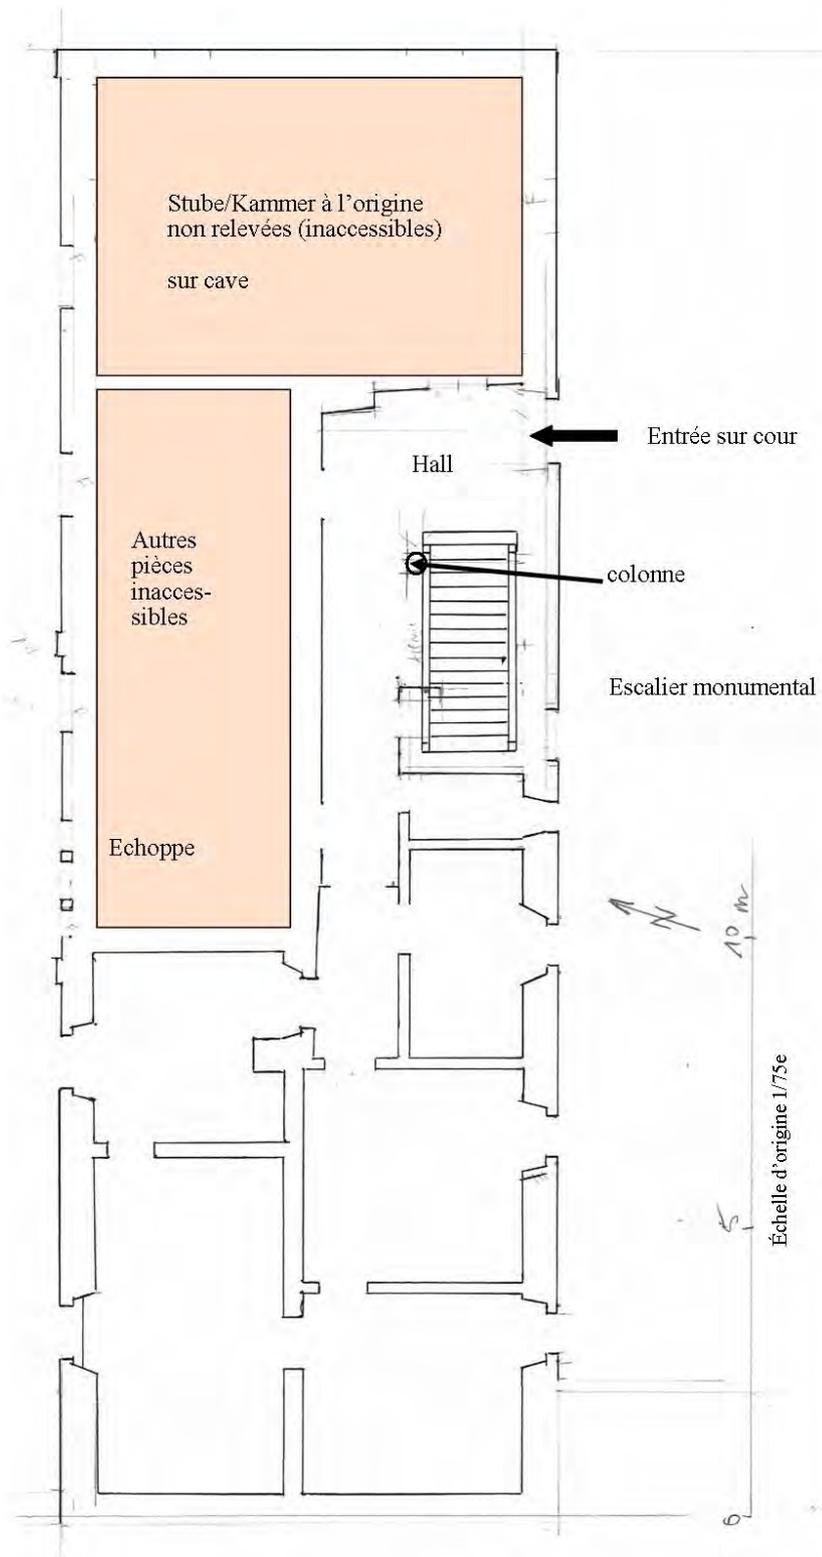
Plan sommaire du rez-de-chaussée (provisoire car l'accès à certaines pièces n'a pas été possible)
